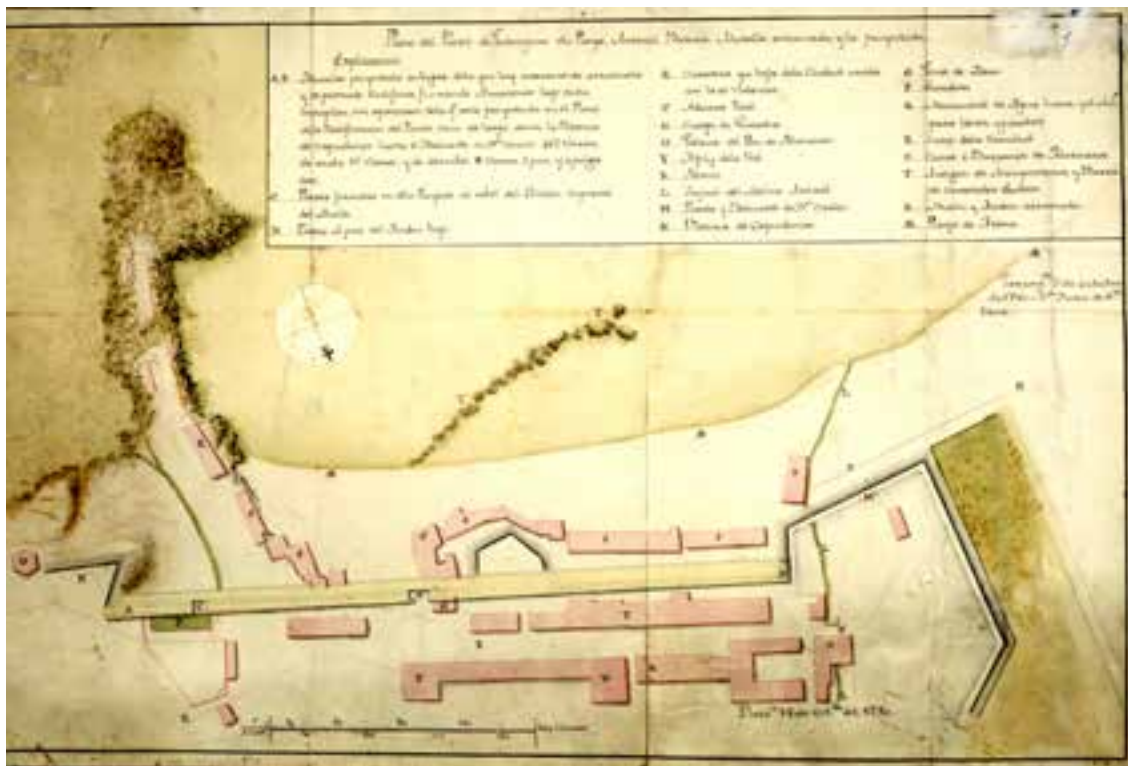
Plano del Puerto de Tarragona, su playa, arraval, batería, muralla arruinada y la proyectada. 2 de octubre de 1780. Juan de Santa Cruz.
